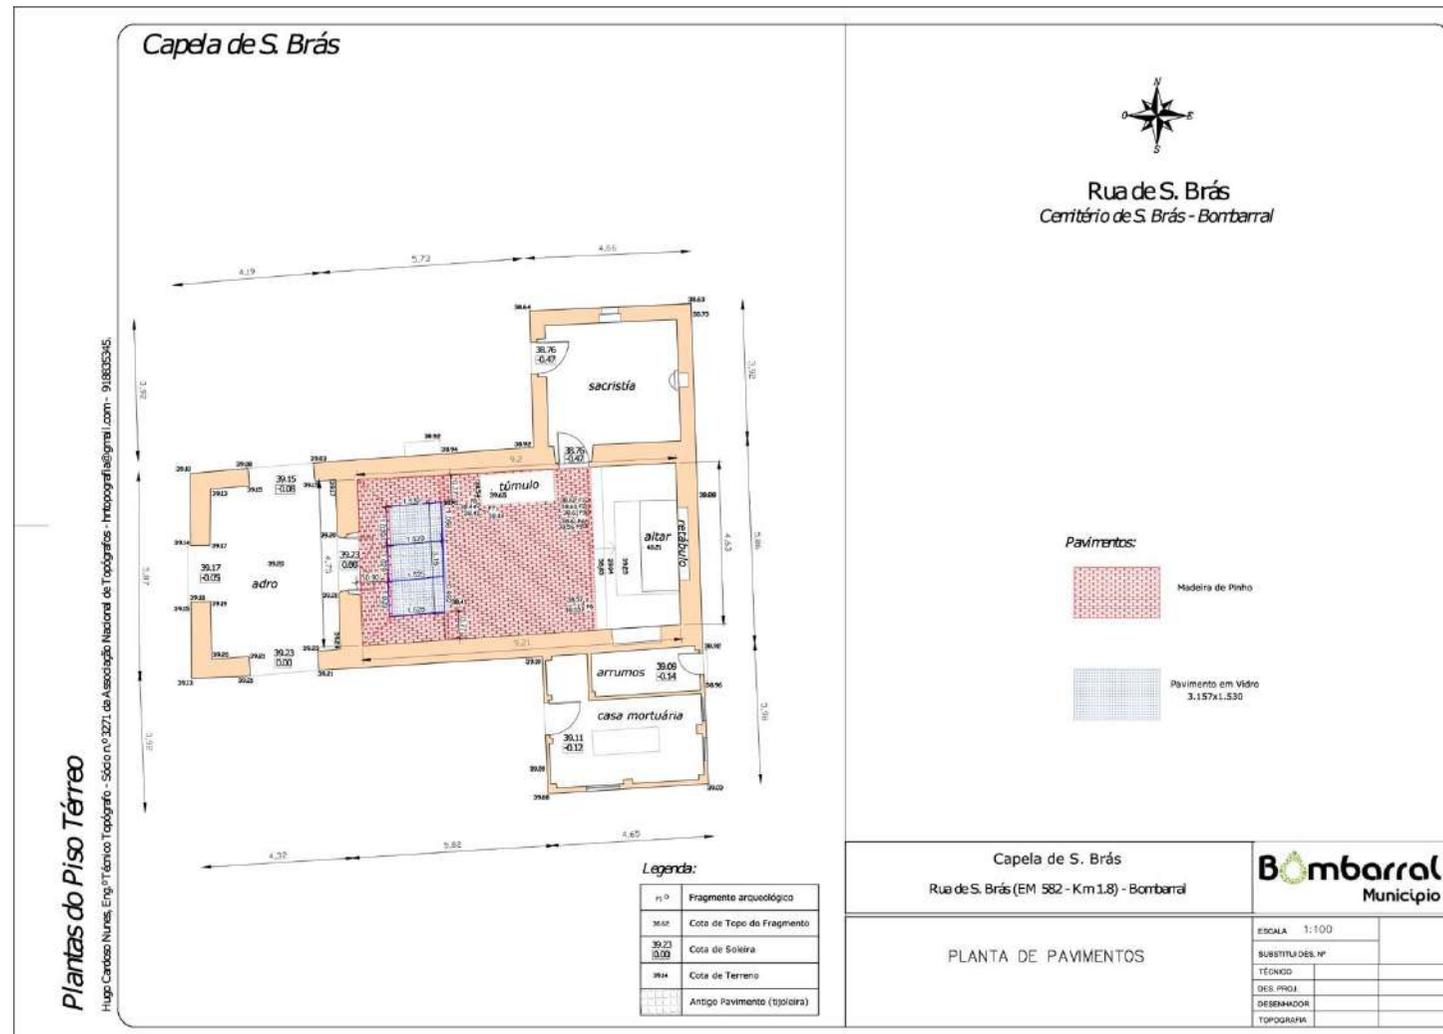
Planta de pavimentos [Município do Bombarral, 2024].
